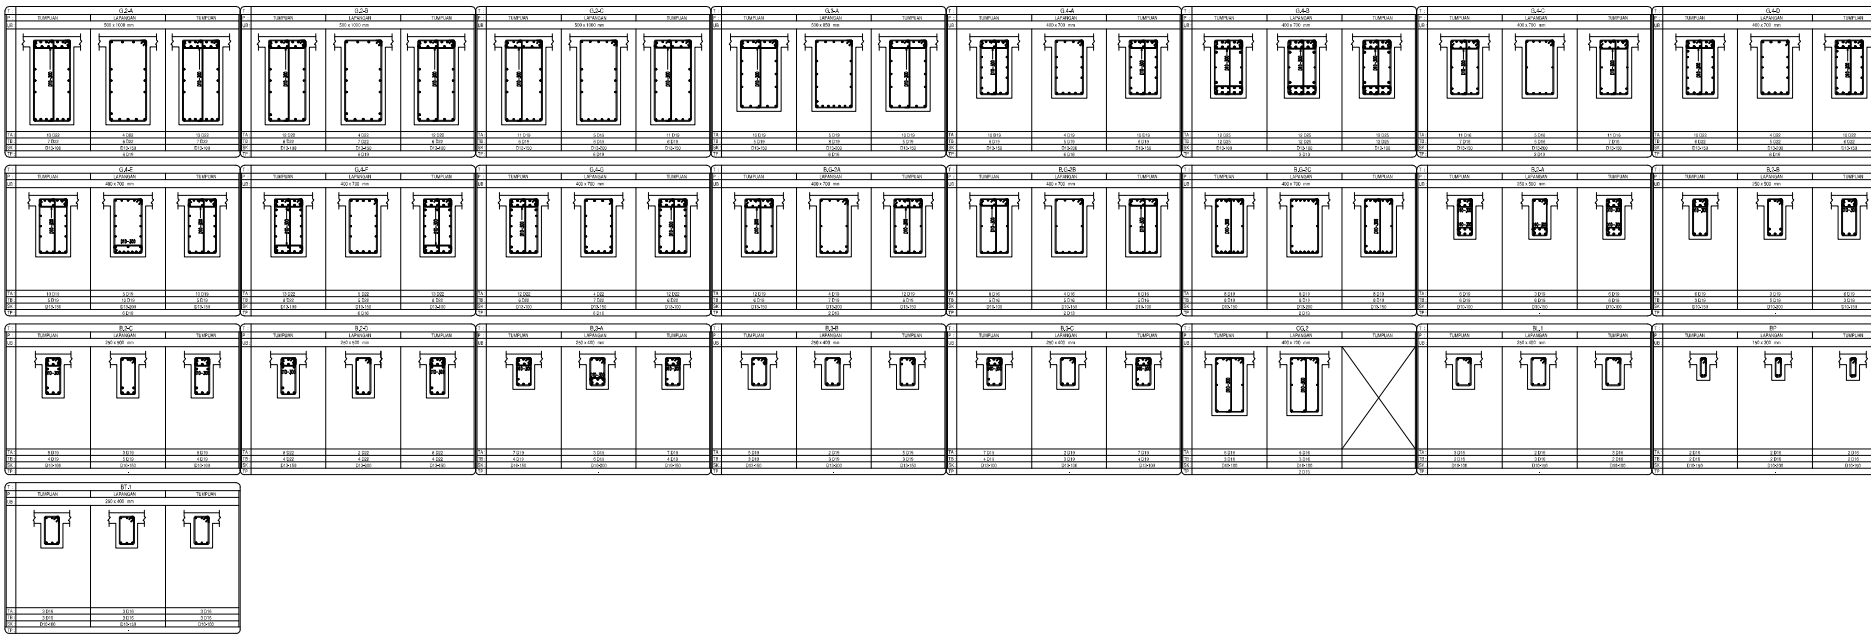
DETAIL PENULANGAN BALOK LANTAI - 5 - 6
